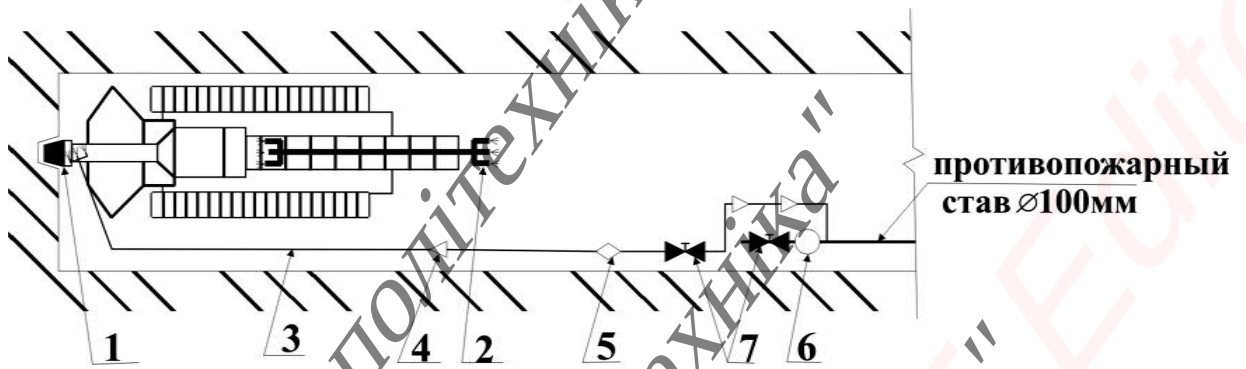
6 - Схема розташування пилоприбивного обладнання: 1 - форсунка зовнішнього зрошення; 2 - зрошувальний пристрій; 3 - рукав напірний; 4 - перехідна муфта; 5 - дозатор; 6 - манометр; 7 - вентиль
